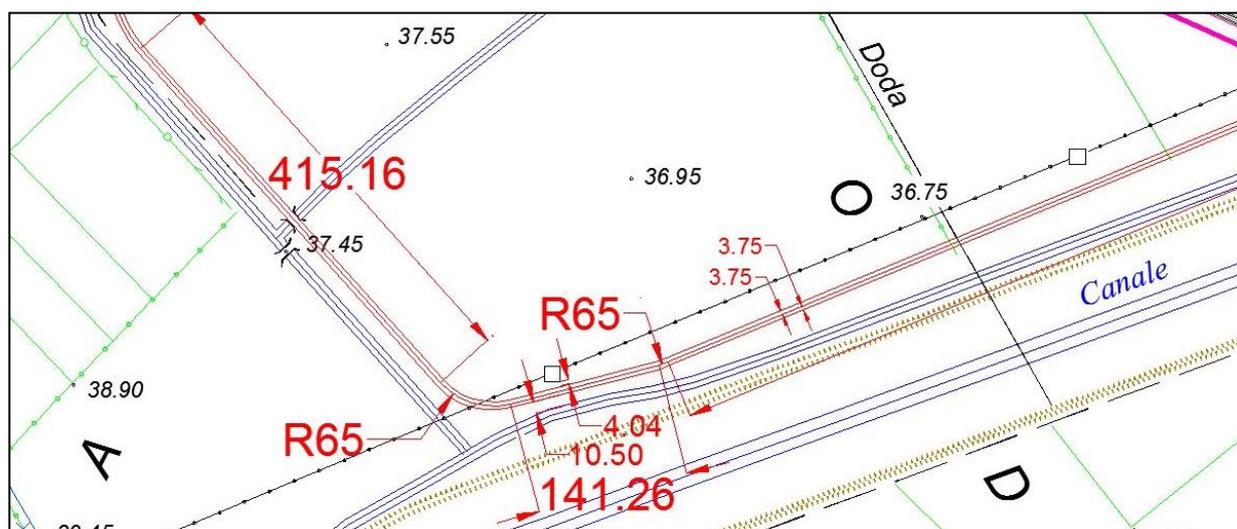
Inquadramento delle distanze di sicurezza rispettate dal tracciato stradale in progetto (Canale Rio Nou 10 m e sostegno della linea elettrica 4.54 m)
